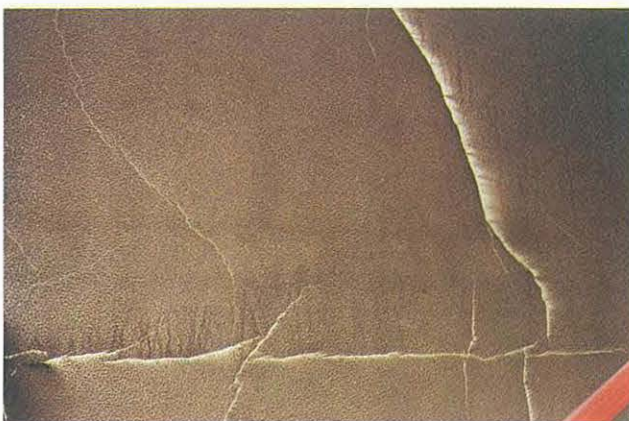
Risse in der Treppenhauswand (Vers. 4) Horizontalriß in Höhe der Geschoßdecke
